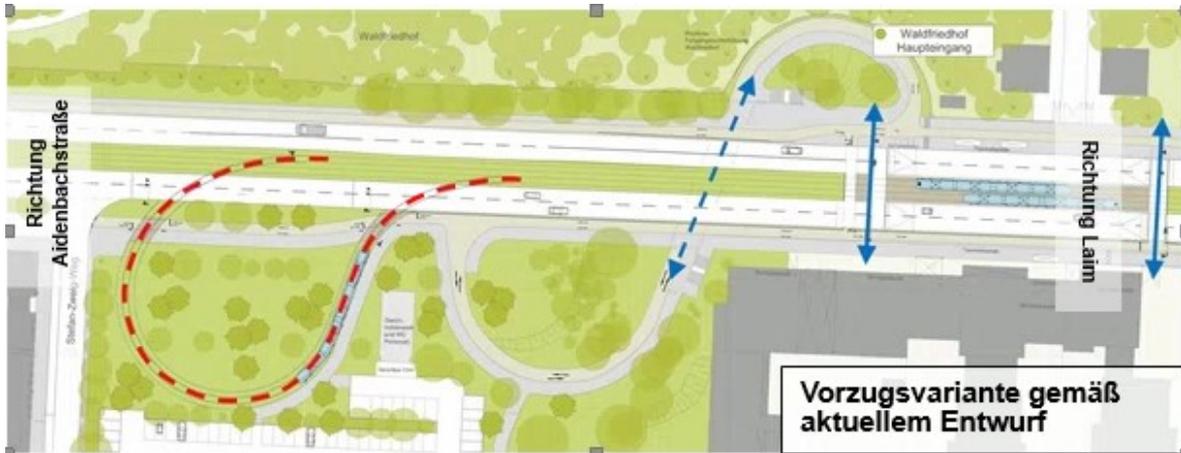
Fürstenrieder Straße, Haupteingang Waldfriedhof: Beibehaltung der Fuß-/Radunterführung, Entfall von 81 Parkplätzen
